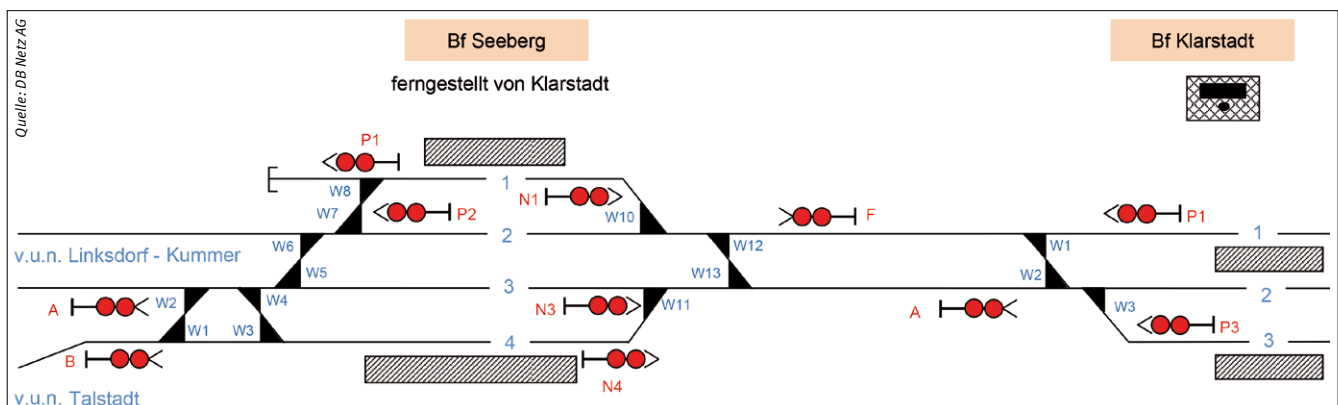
Lageplan Bf Seeberg und Klarstadt
